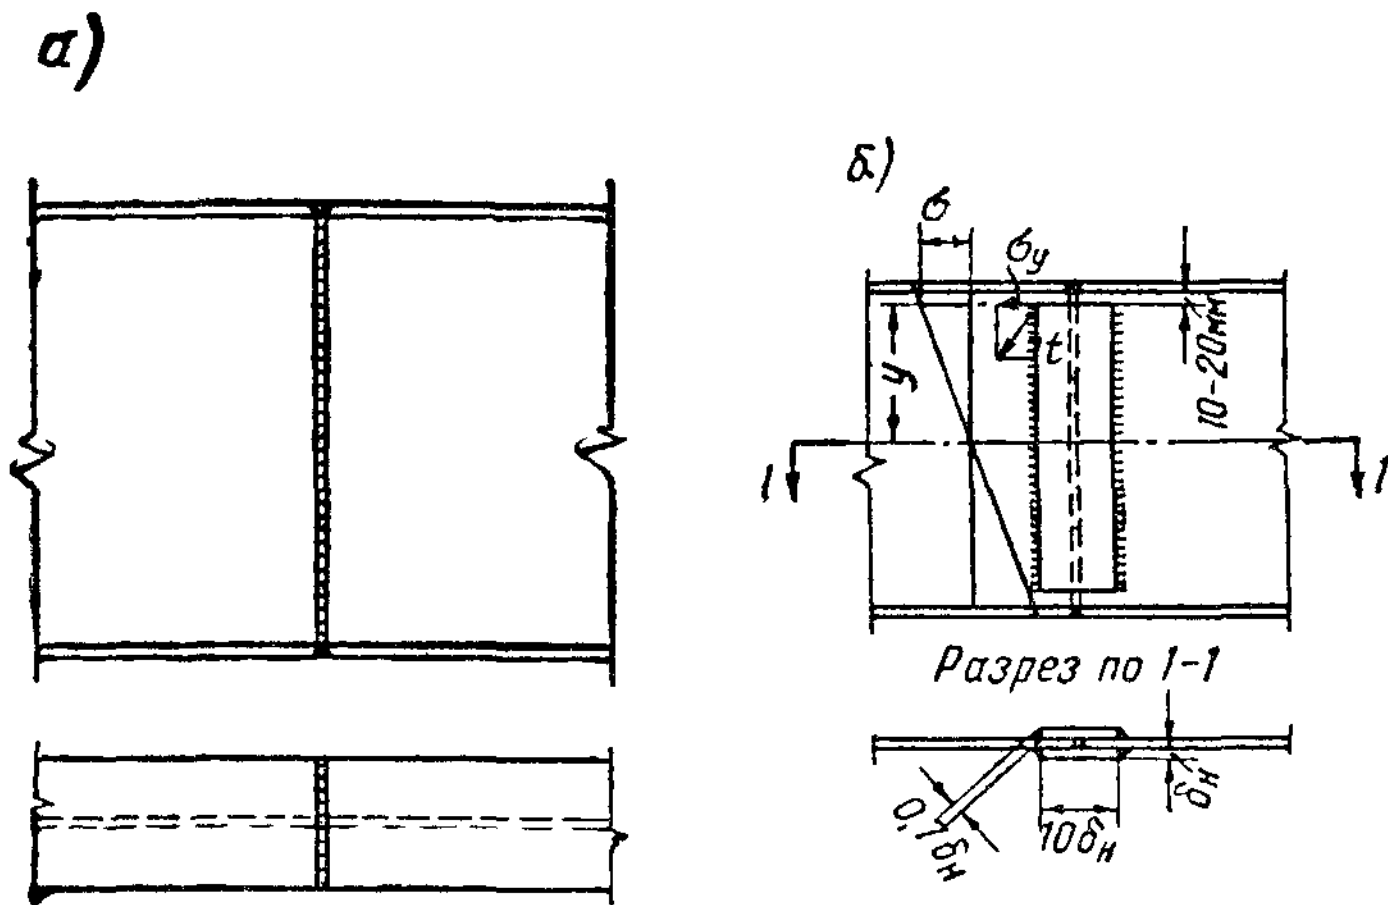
Типы стыков стенки сварных балок
